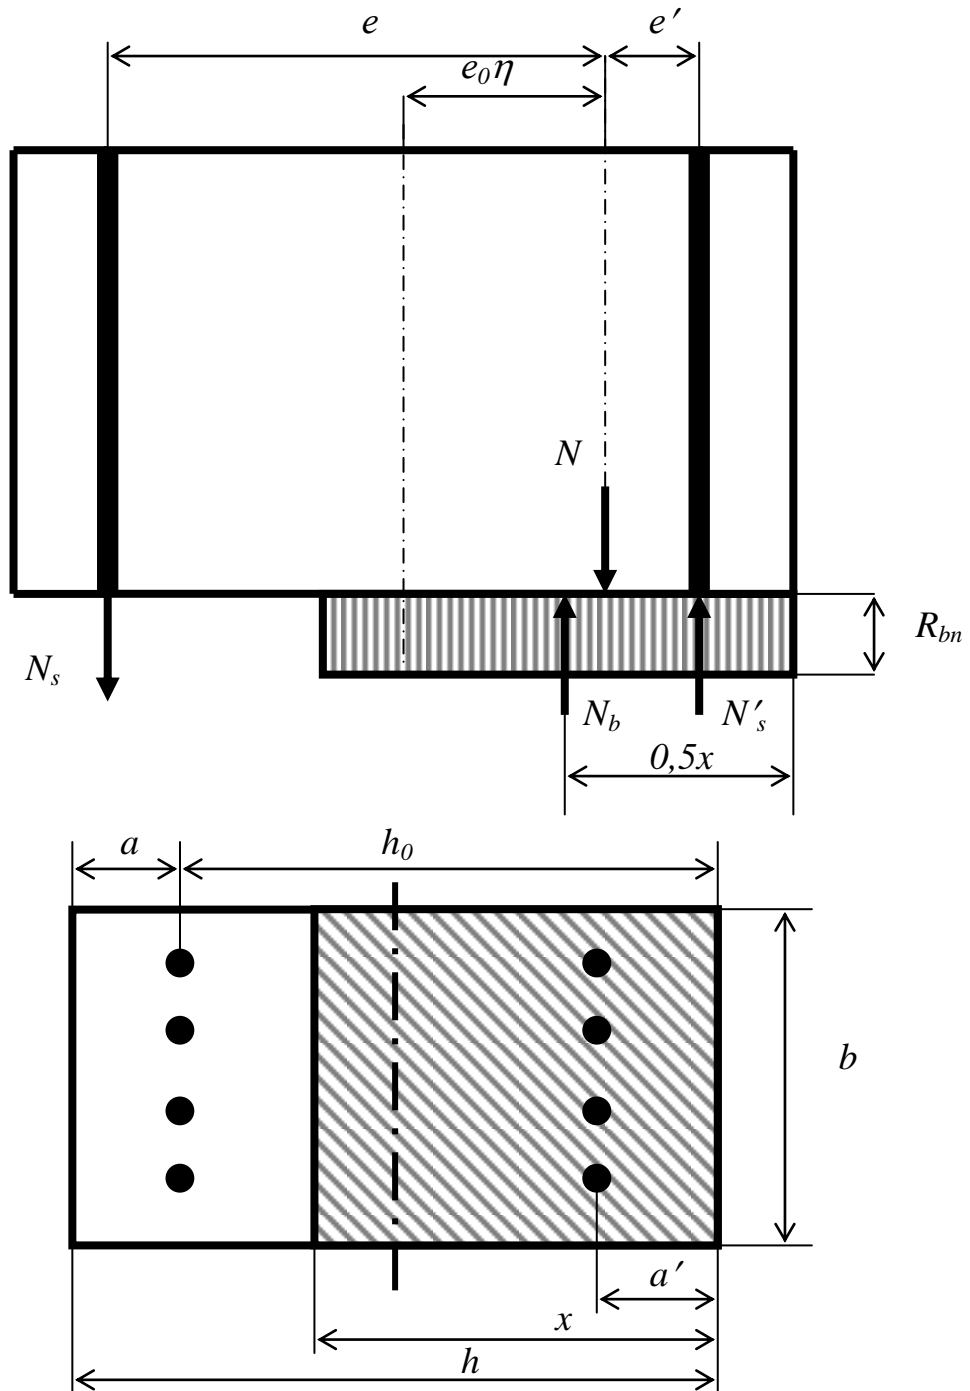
Розрахункова схема залізобетонної колони для випадку 2
